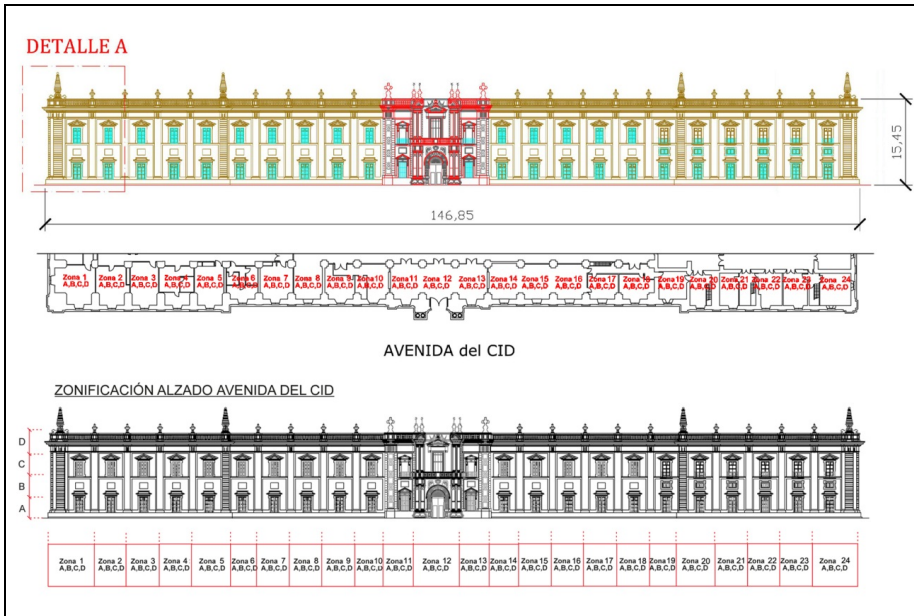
Alzado, Planta baja y zonificación Fachada Avenida de EL CID
